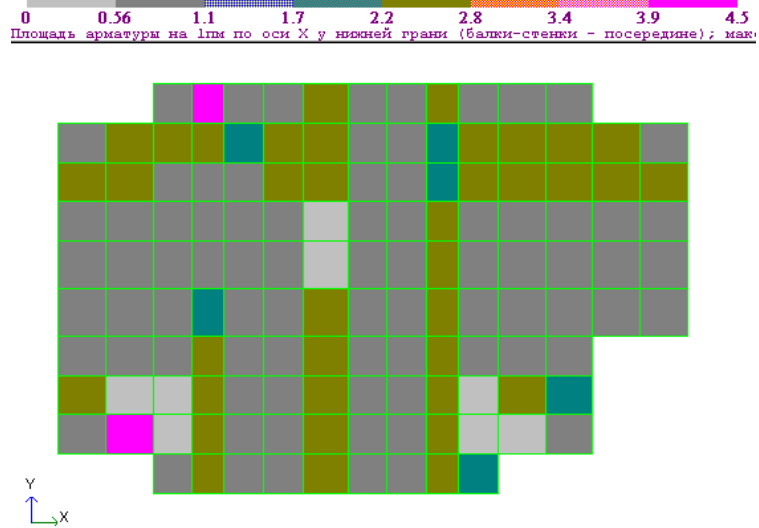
Площадь арматуры на 1 п/м по Оси X у нижней грани
